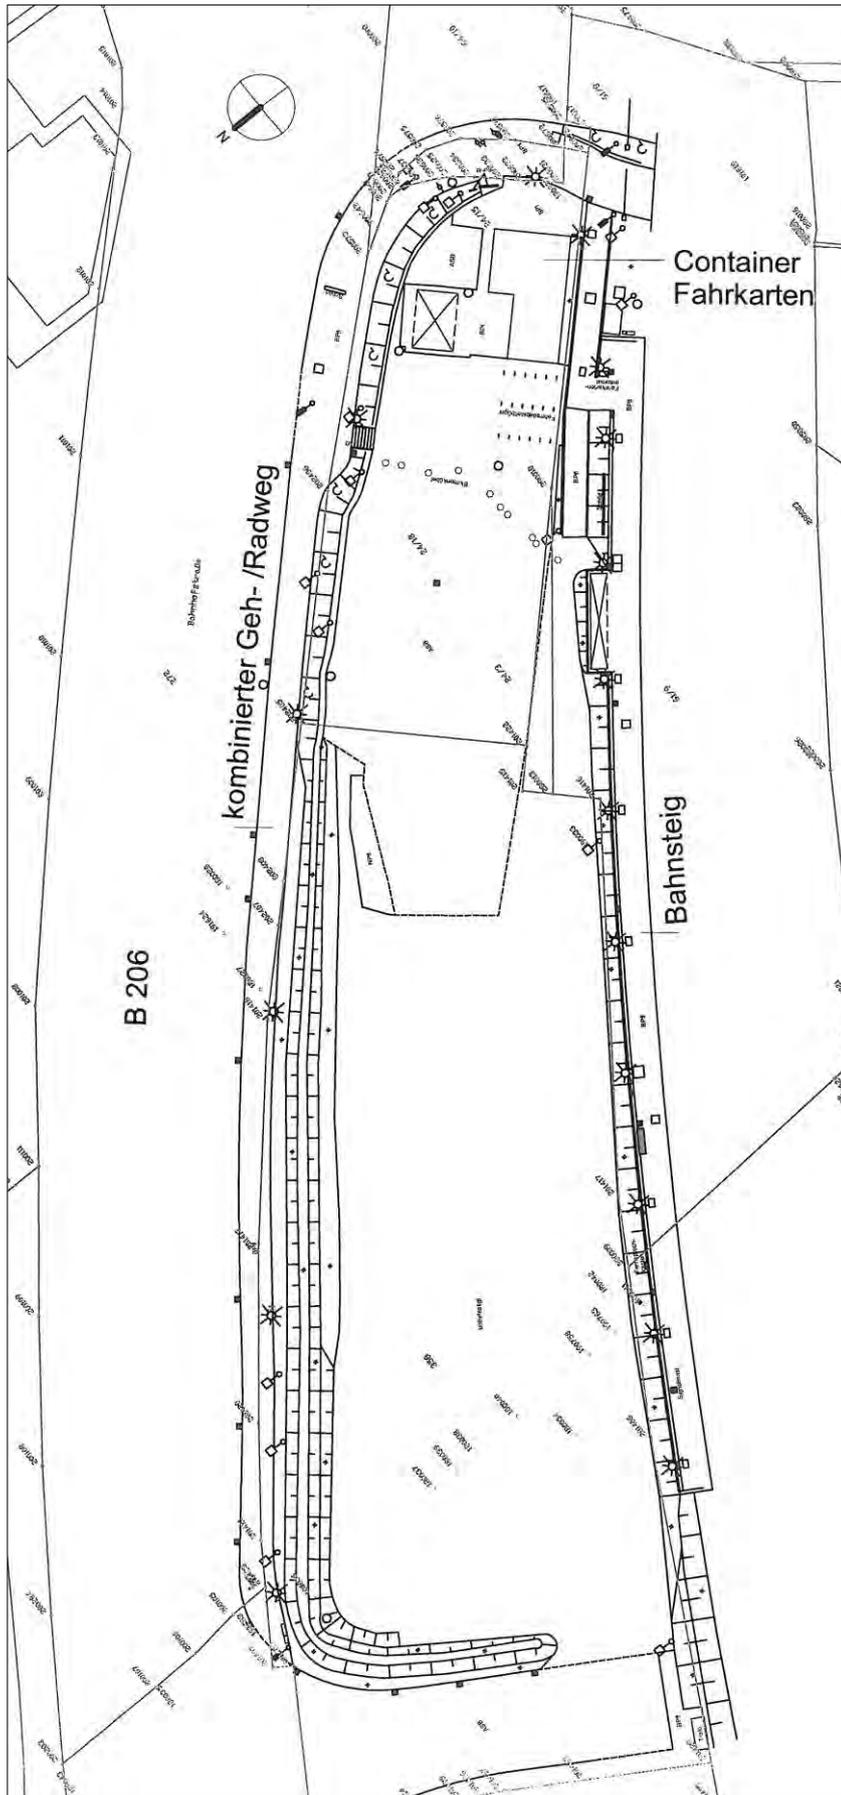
Lageplan Vermessung vom 10.01.2013 (Vermessungsbüro Jamke)
